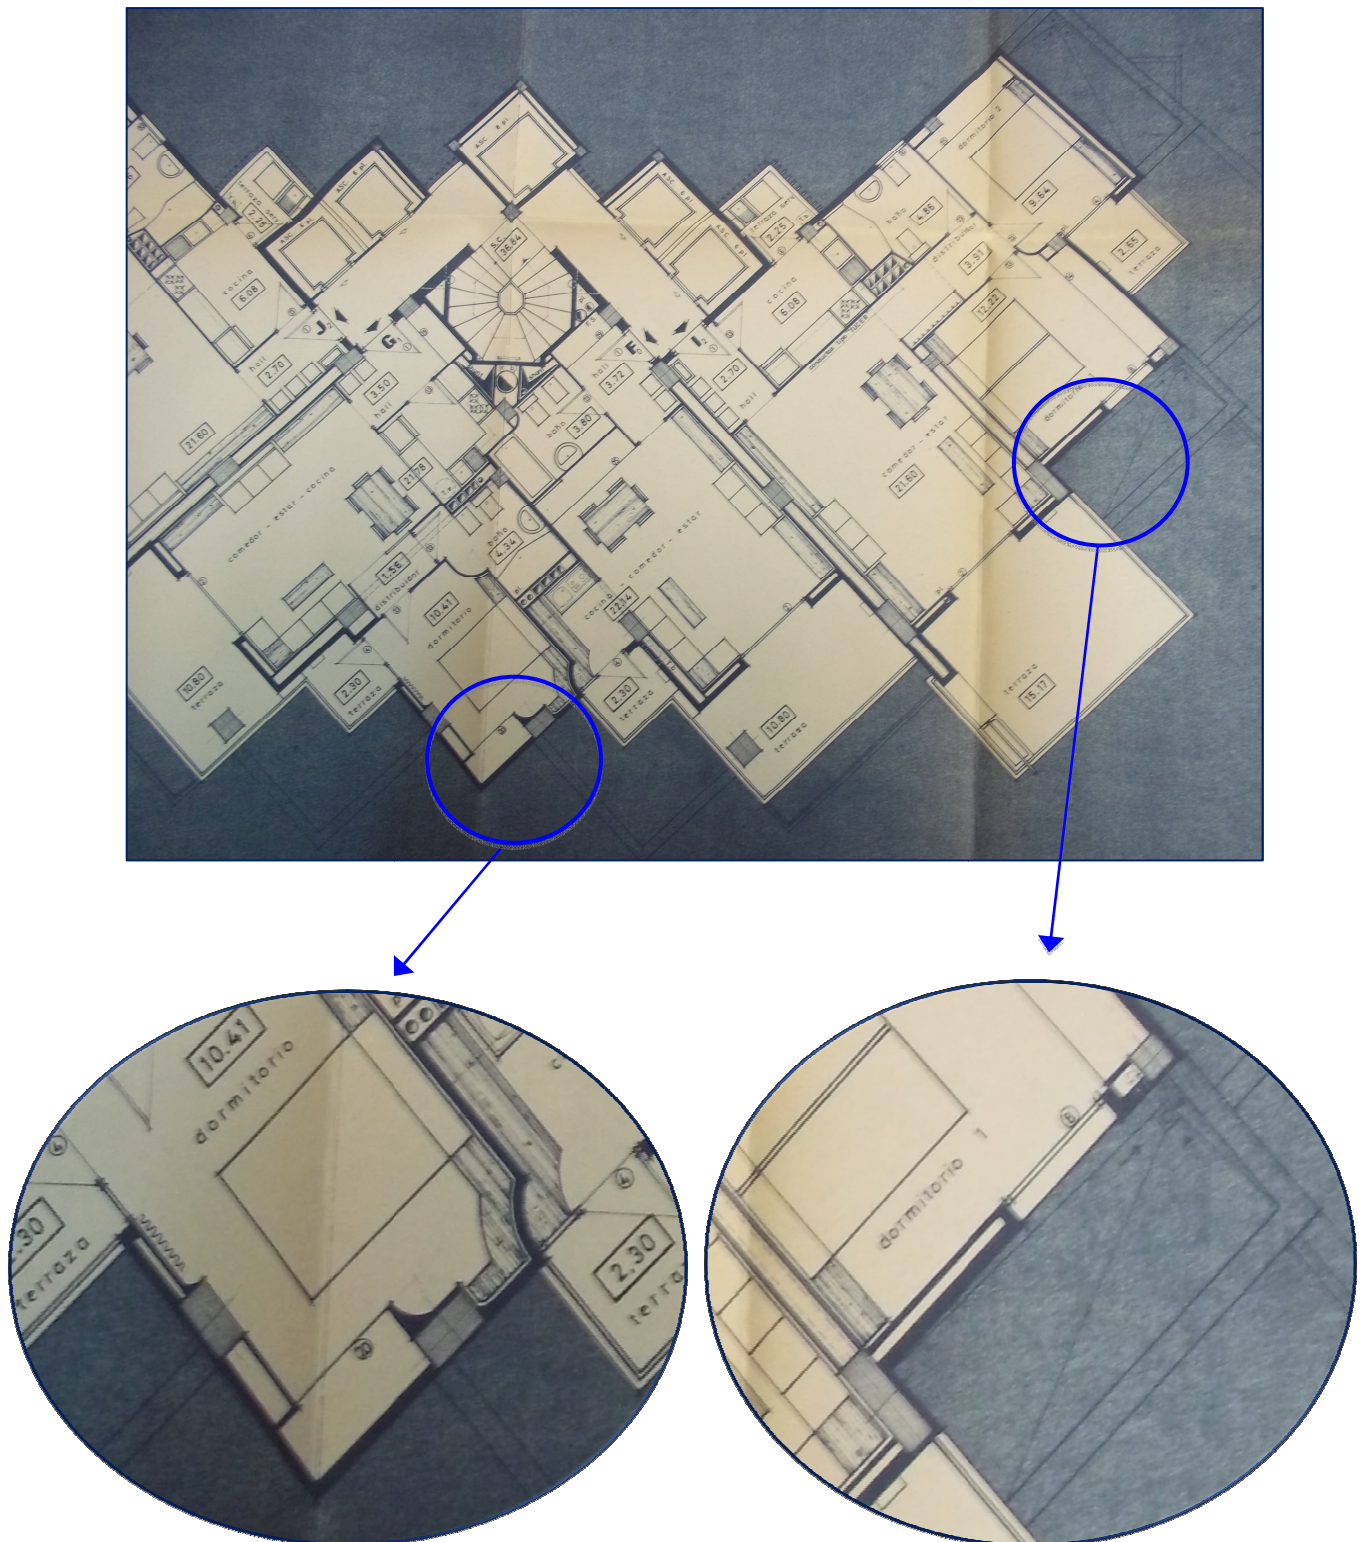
Planta de distribución y detalles de pilares de fachada y de esquina.
